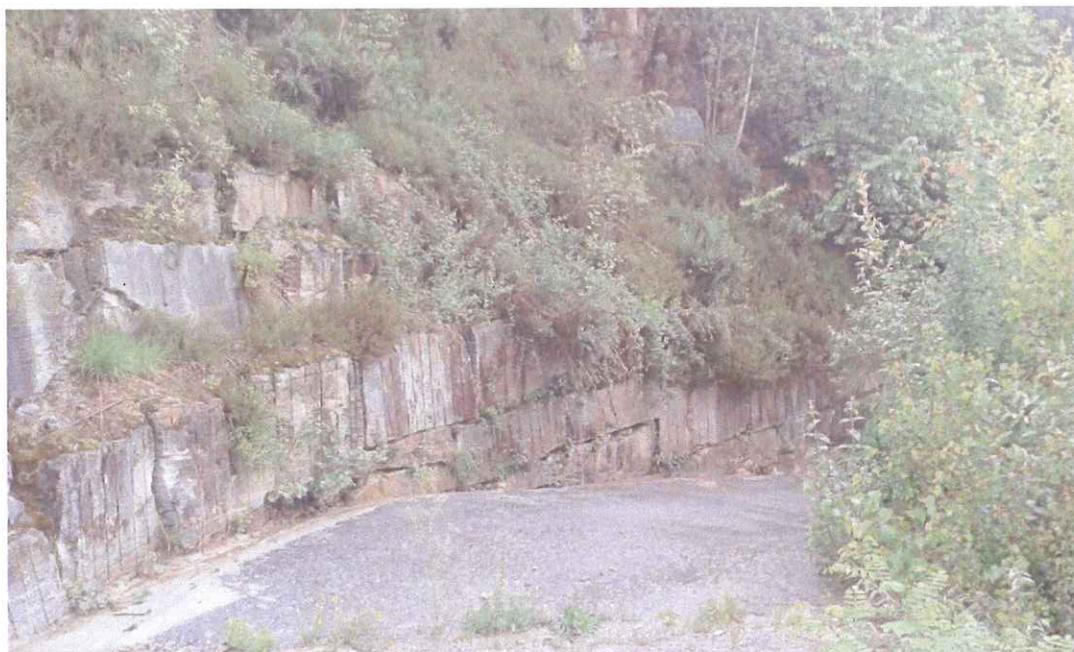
la parte est della porzione in stima con il muro di sostegno
